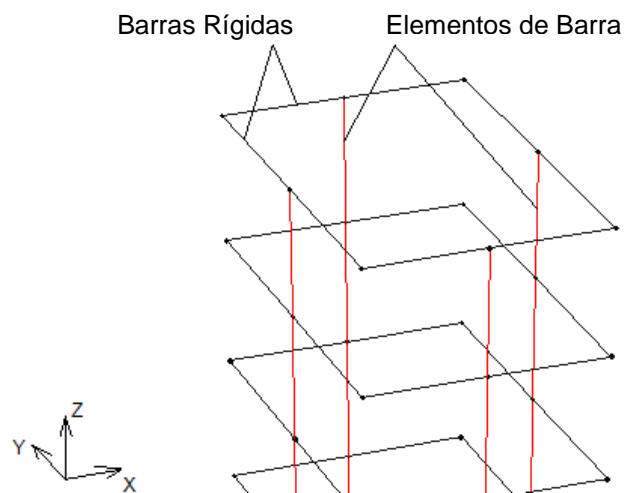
Pormenor de modelação do núcleo central sem aberturas para Elementos de Barra
